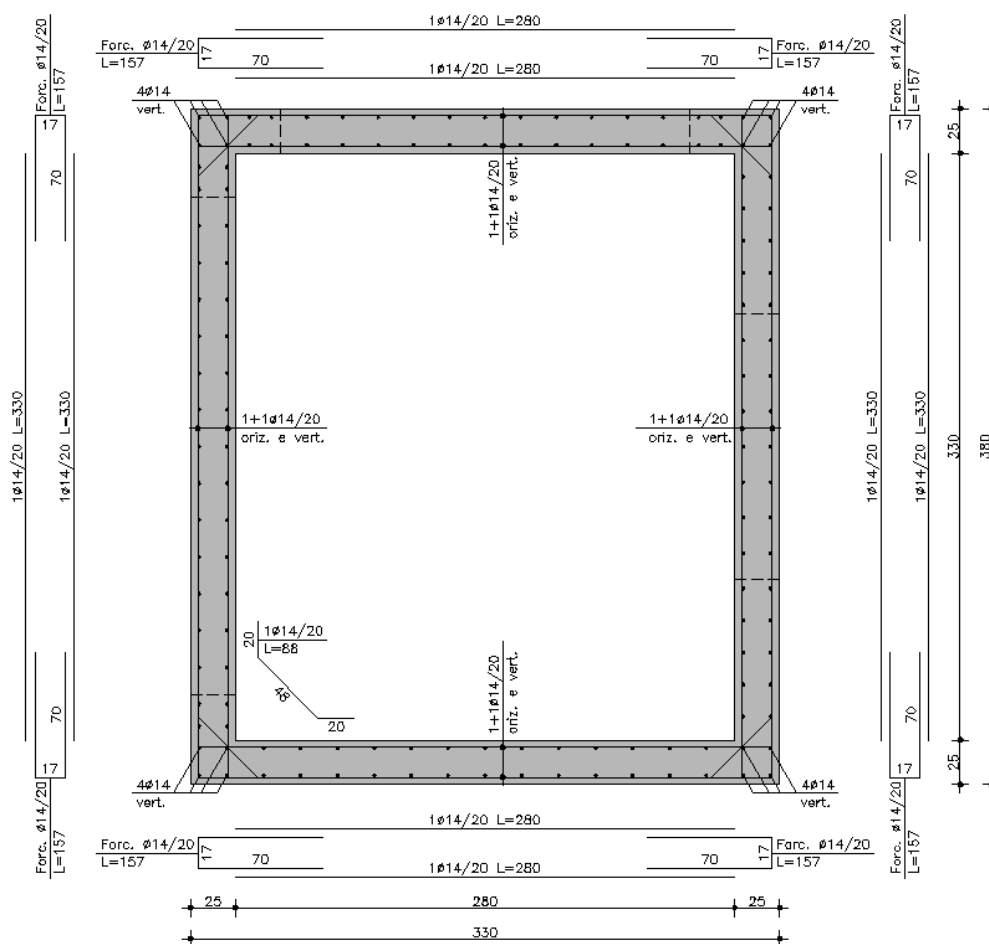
Pozzetto E- Sezione orizzontale D-D
